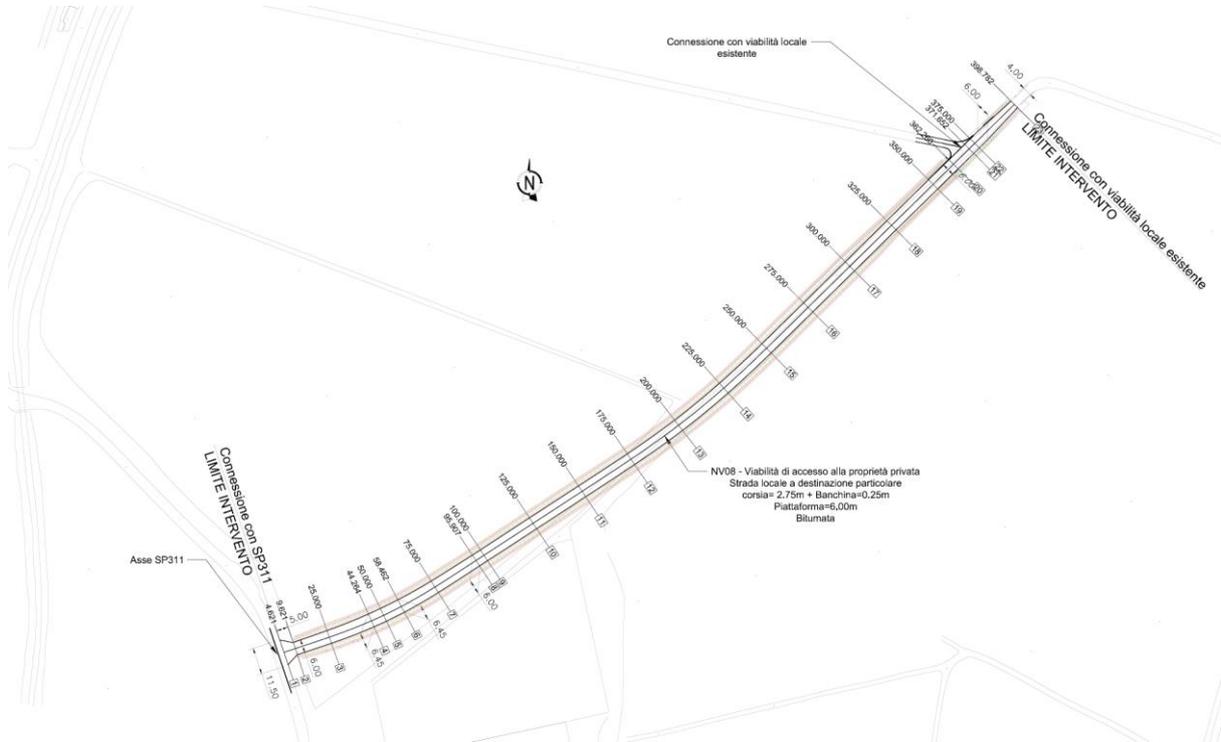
Stralcio planimetrico – NV08\_Viabilità di accesso proprietà privata
